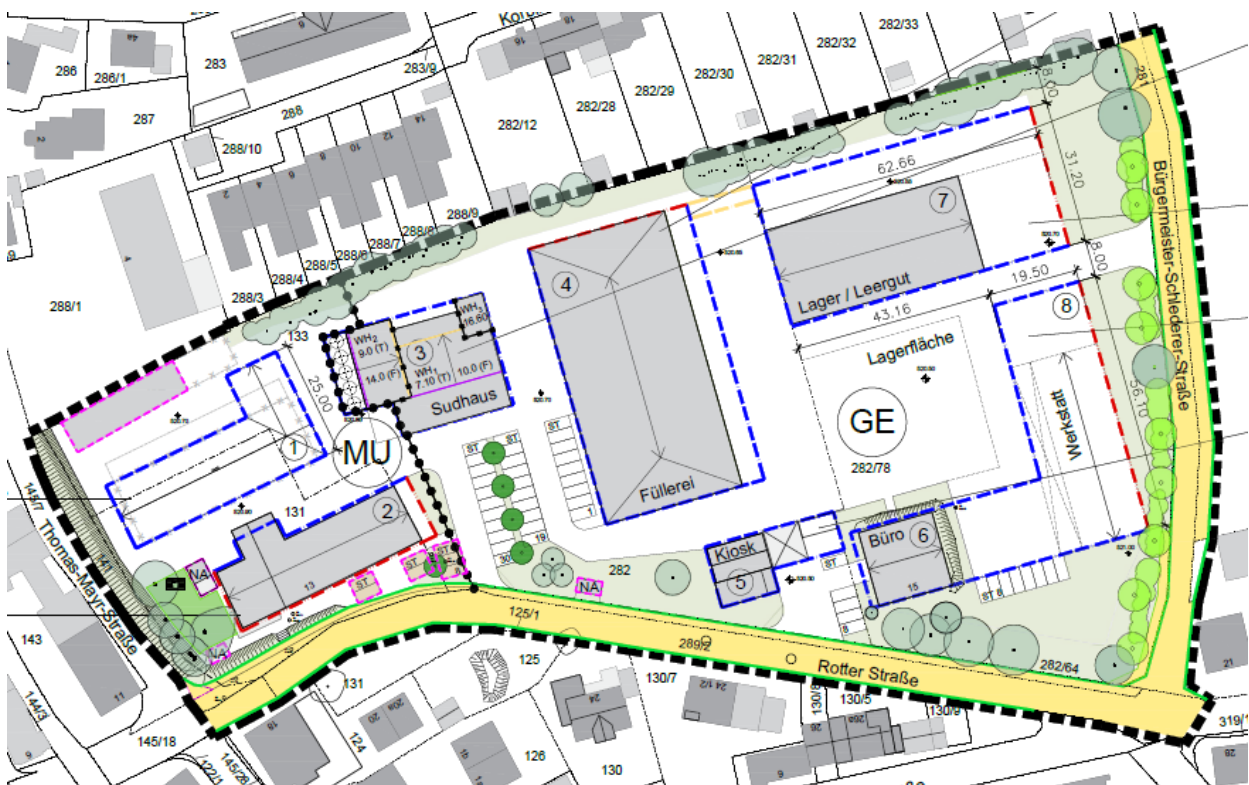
; Darstellung Planzeichnung; eigene Darstellung ASP, Dez 25
